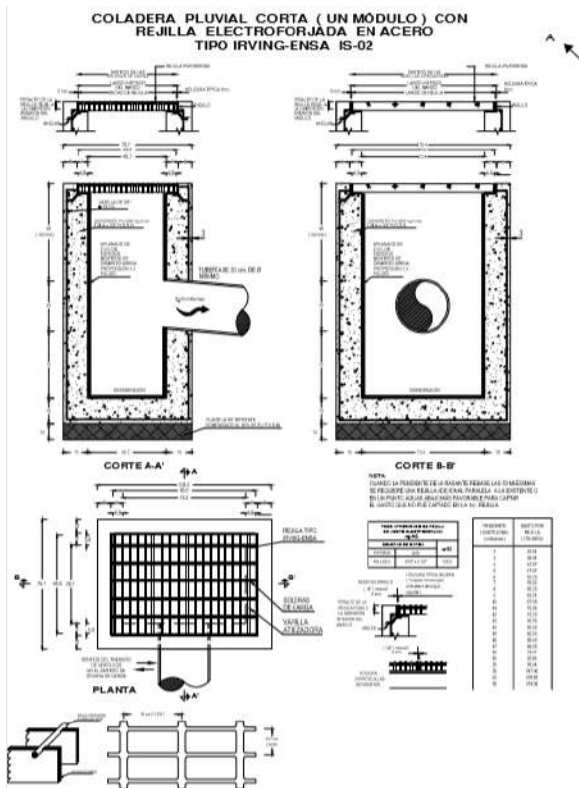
Detalle de Coladera pluvial localizada en calle Viznaga. Plano de drenaje pluvial de la calle.
